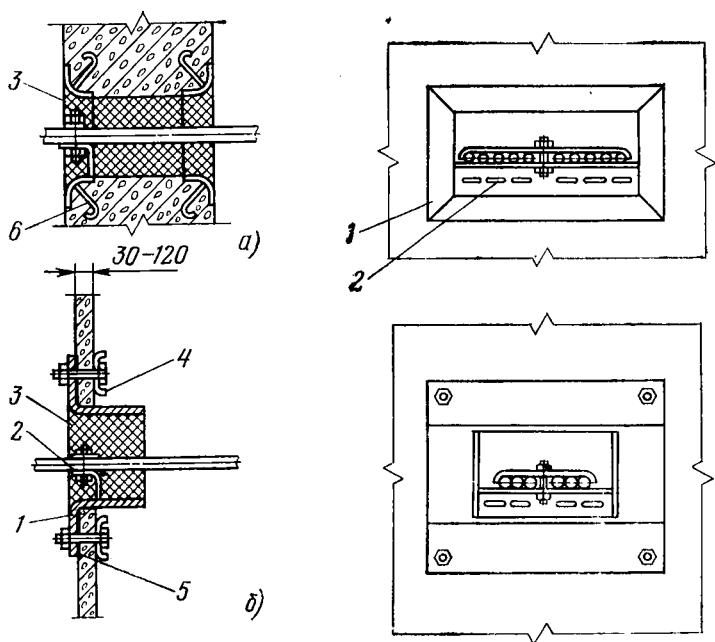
Открытый проход трубных блоков через проемы в бетонных и кирпичных стенах.
